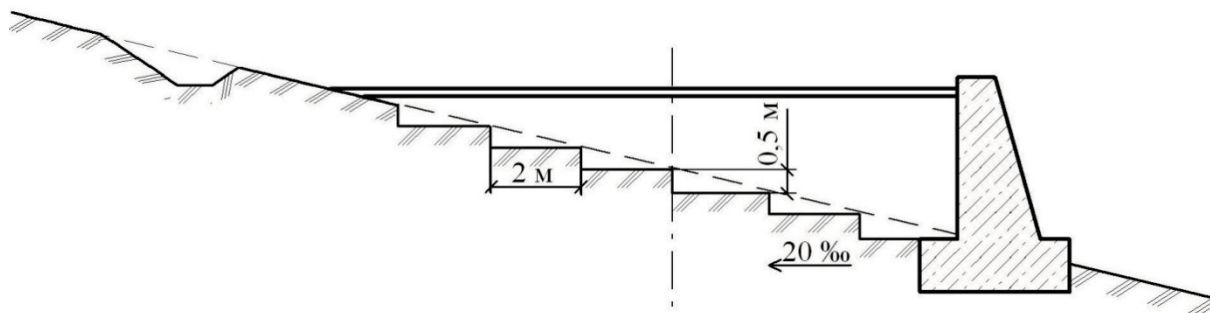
Насыпь на косогоре с подпорной стенкой
